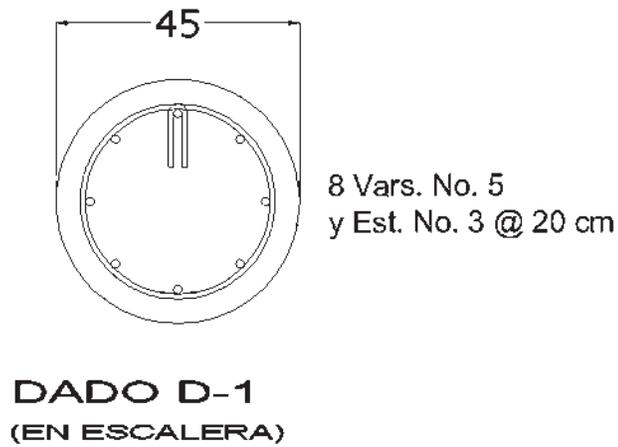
Sección de dado de cimentación del descanso de al escalera
